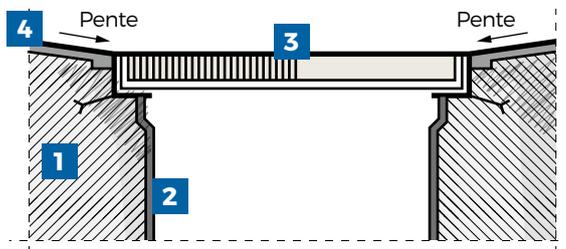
Exemple de traitement d'un arrêt sur caniveau, galerie technique, etc.
